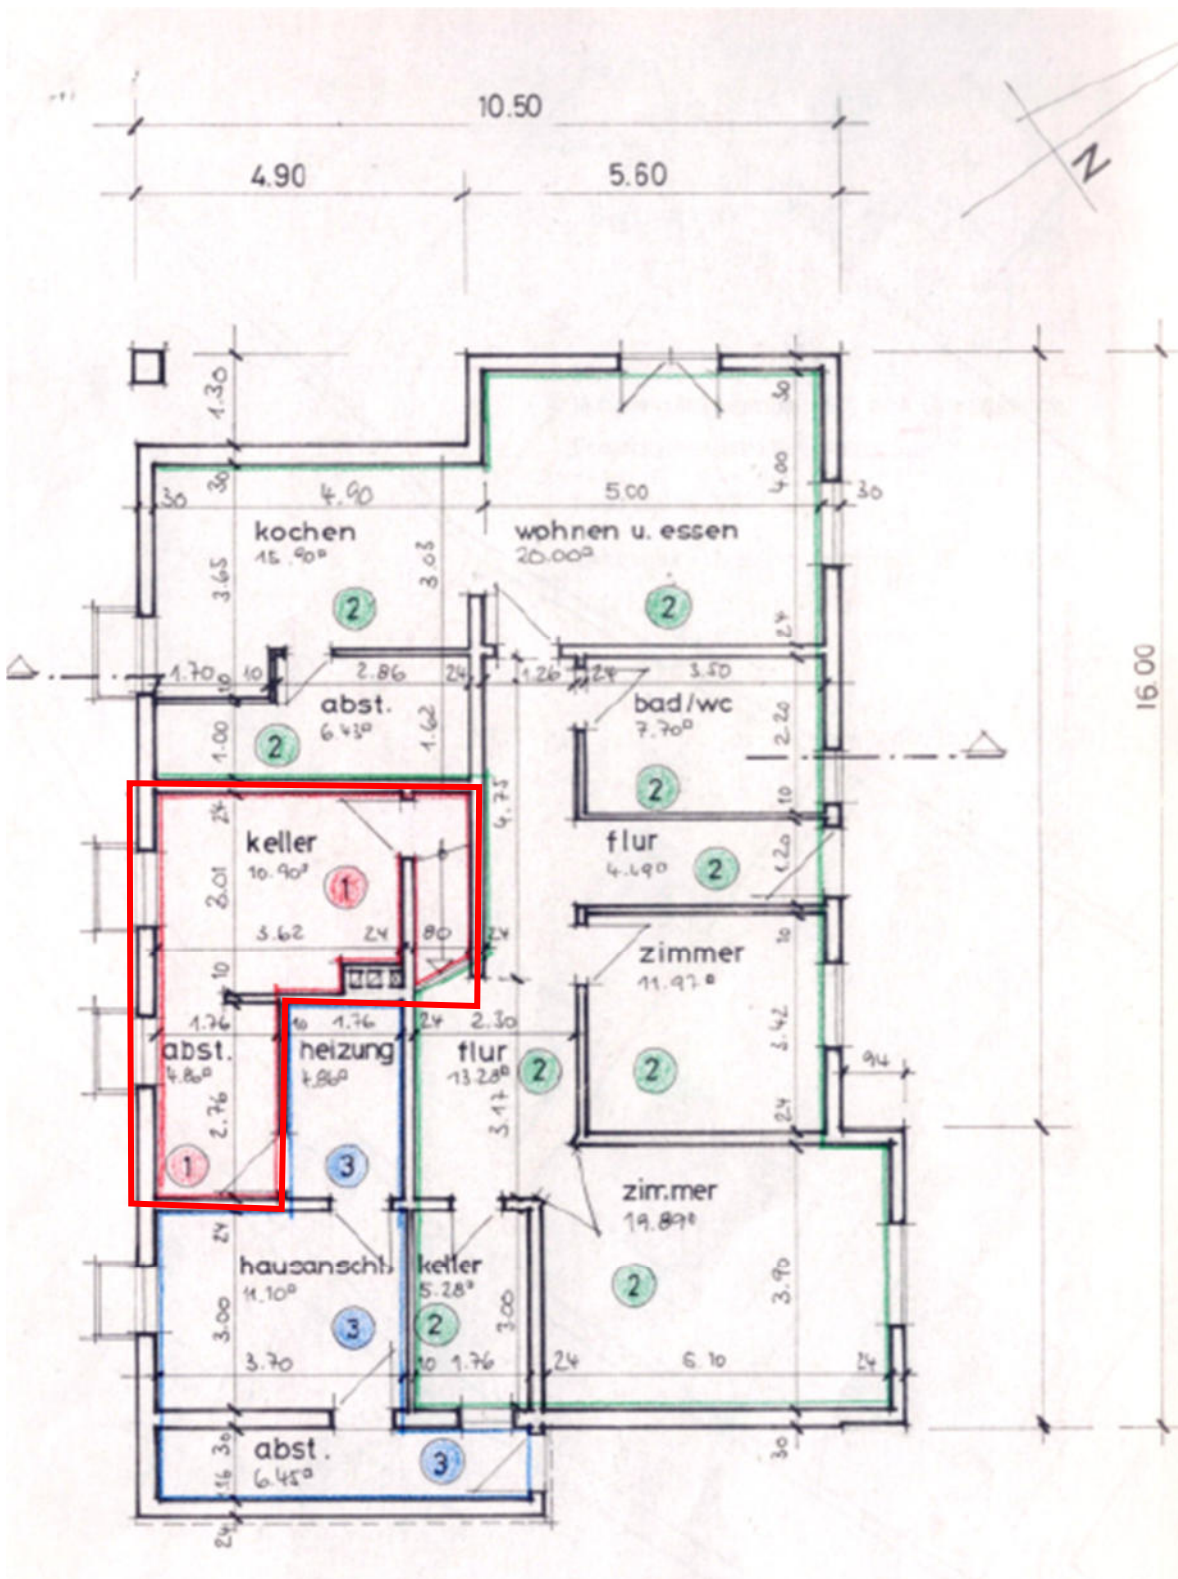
Grundriss Untergeschoss (ohne Maßstab); Detail Kellerraum zum Sondereigentum Wohnung Nr. 1; Quelle: Teilungserklärung vom 30.12.1998 (UR-Nr. 156/98), Aufteilungspläne; Roteintragung durch den SV
